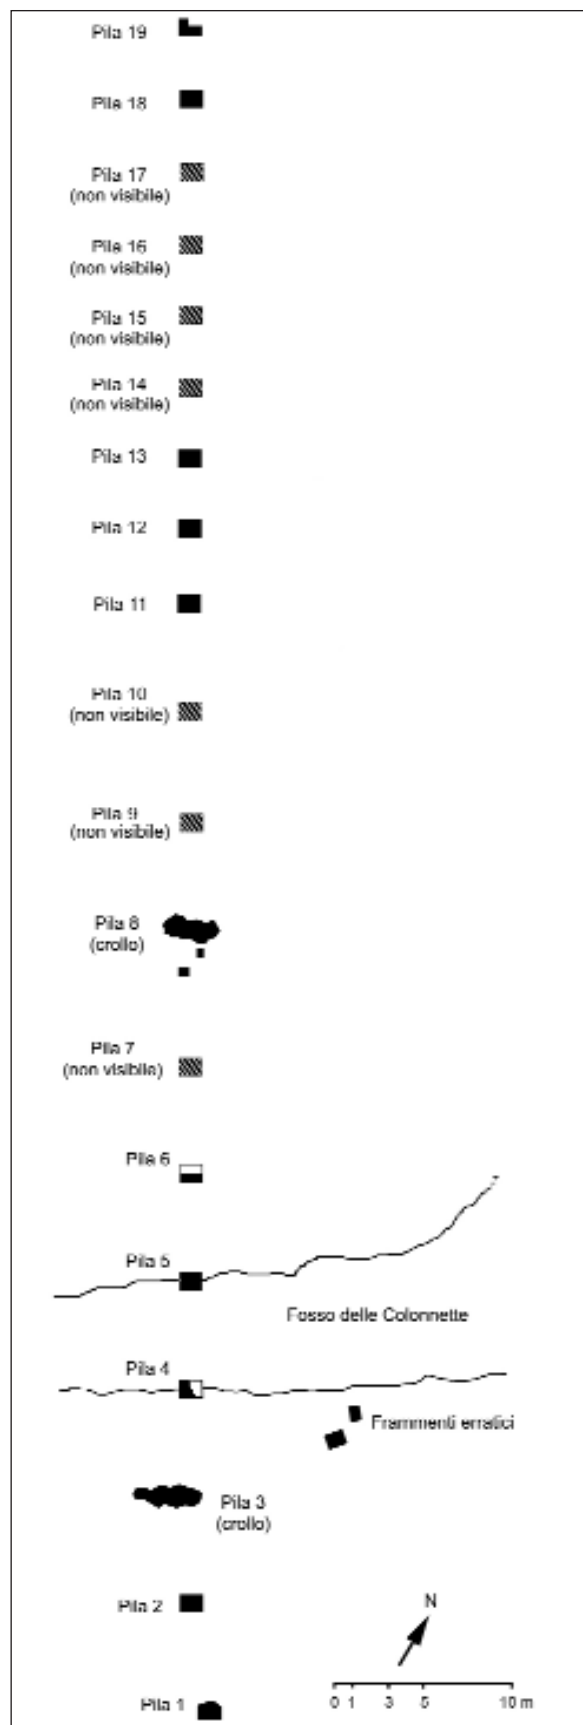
Planimetria dell'acquedotto delle Colonnette.
